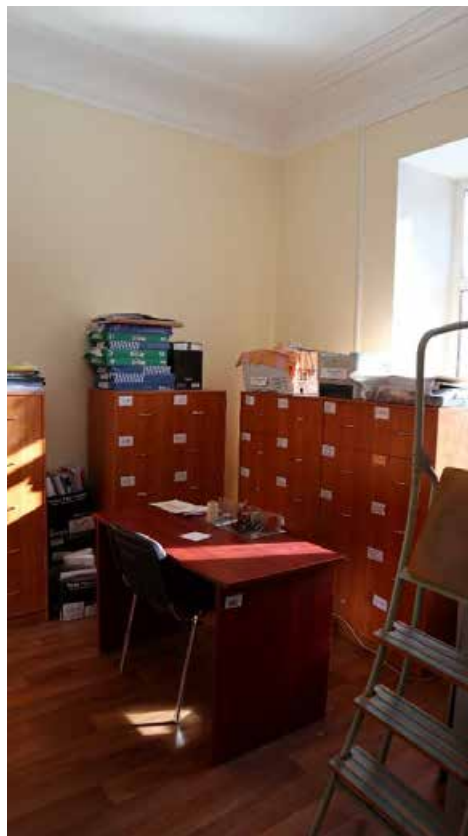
2 этаж, помещение 1-Н (400). Фото 2.121. 2 этаж, помещение 1-Н (401).
